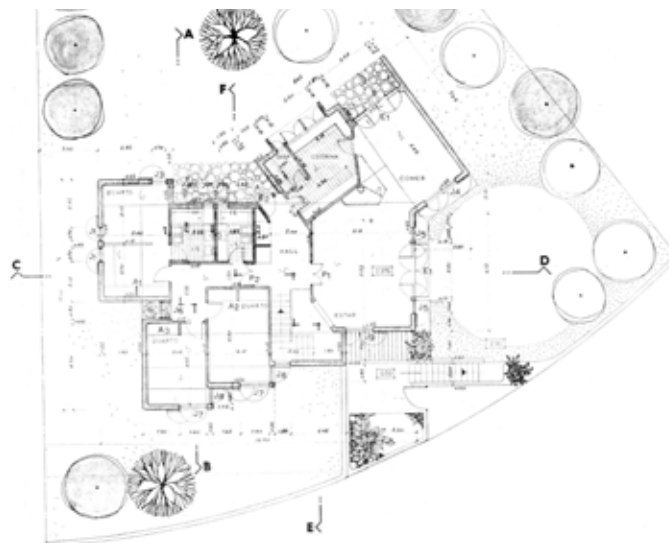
Casa Waltrand Franz, António Abrantes, 1969. Planta piso 1.
